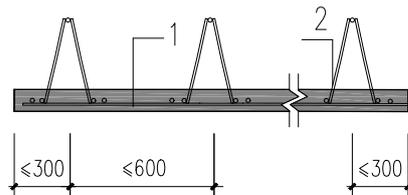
叠合楼板中钢筋桁架布置示意图
